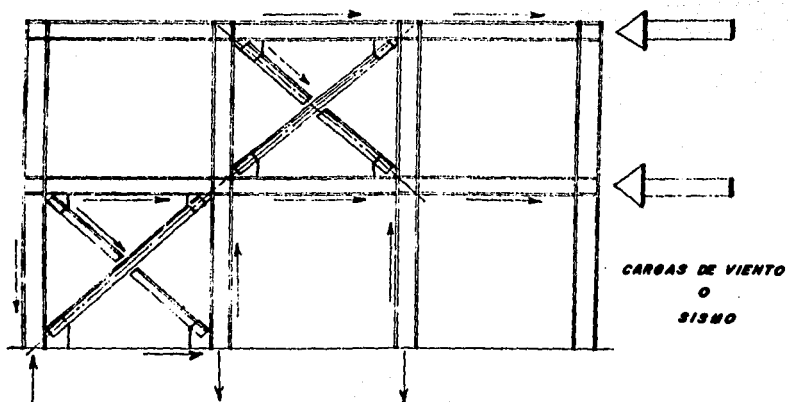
Armaduras verticales de arriostramiento cruzado.
